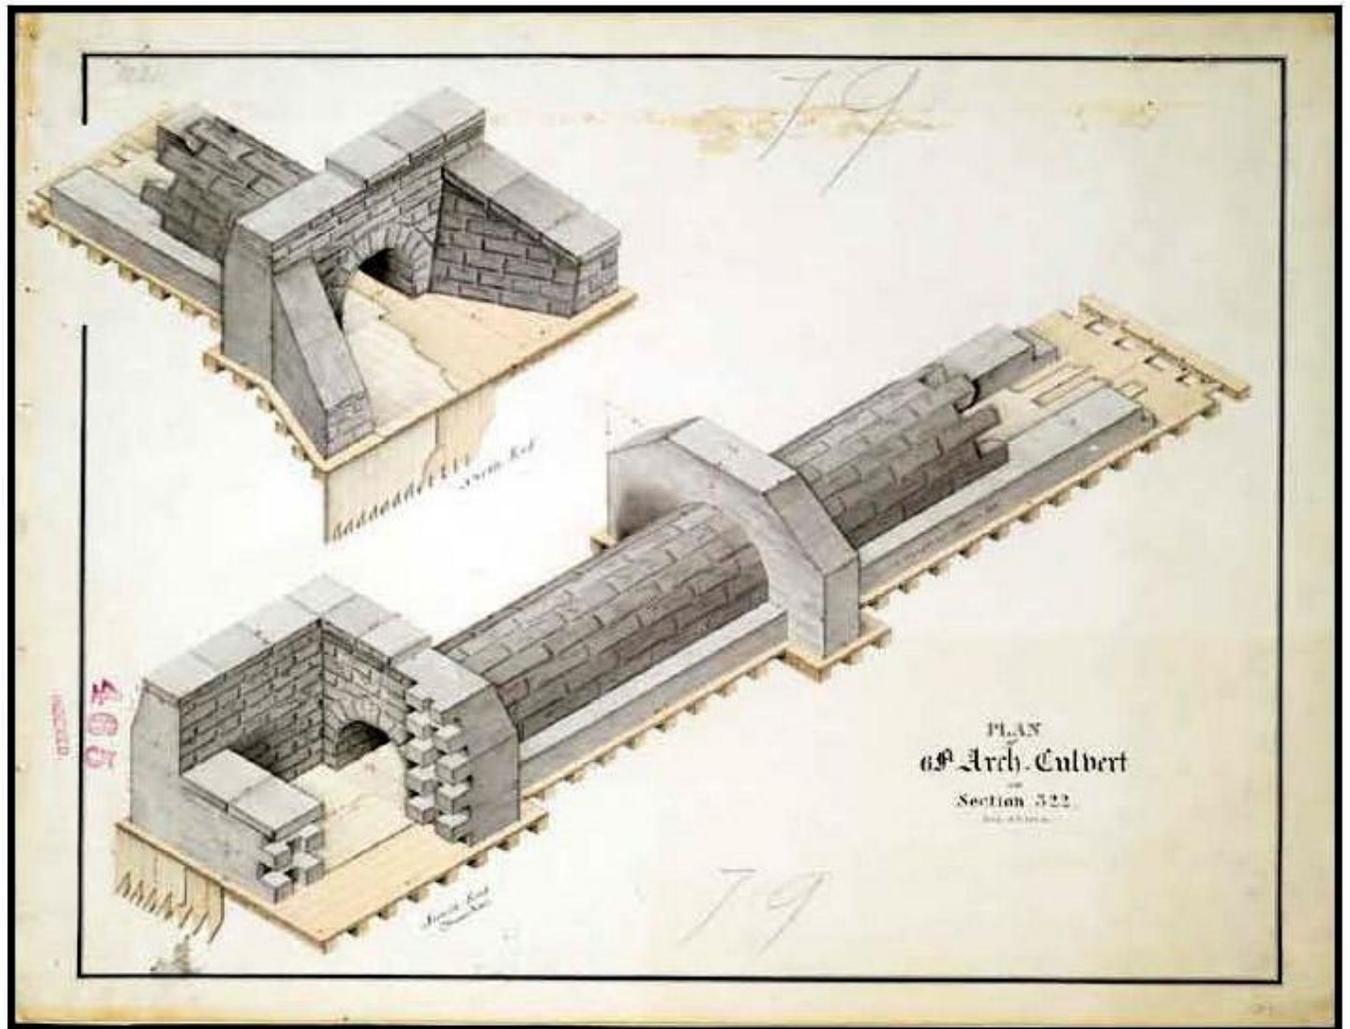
Plan of 6 Ft. Arch-Culvert on Section 322.* Cet aqueduc est intégré au canal Érié, dont la partie originale est achevée en 1825. Collection *New York State Archives* (Bergeron Gagnon, 2009 : figure 26)
